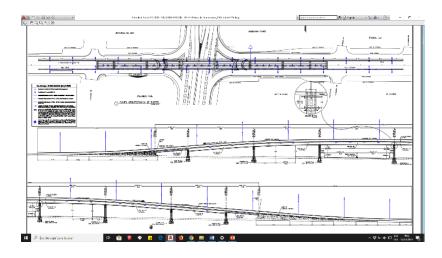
Revisión de plano eléctrico del puente de la segunda calle.
